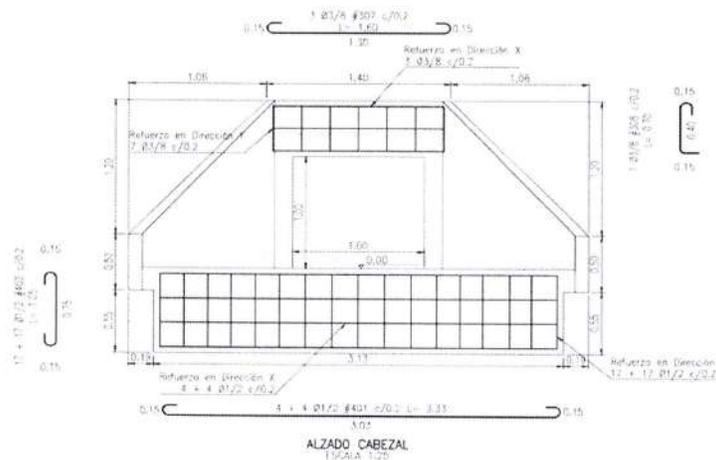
Sección típica y detalle del acero de refuerzo de las alcantarillas cajón o box culvert de 1.0x1.0m en Tramo Vial Mariangola – Villa Germania.
